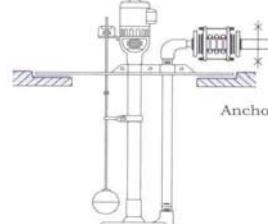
泵浦進、出口端。Pump : inlet/outlet
